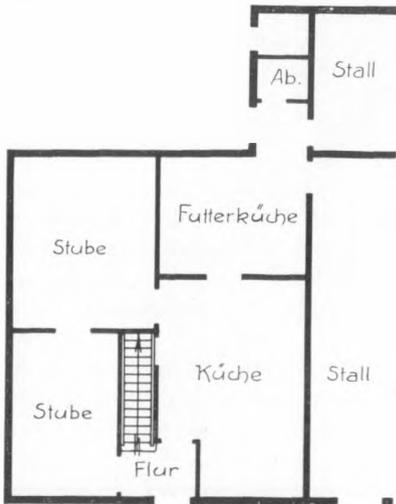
Angebautes Wohnhaus mit 3 Wohnräumen und Futterküche im Erdgeschoß, Ausbau von 2 Dachgeschoßzimmern an der Brandmauer ist möglich.
